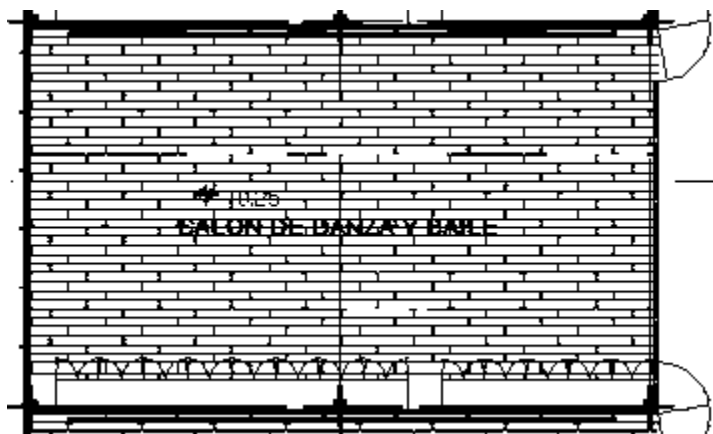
area de estudio. Fuente: Plano arquitectónico del proyecto
